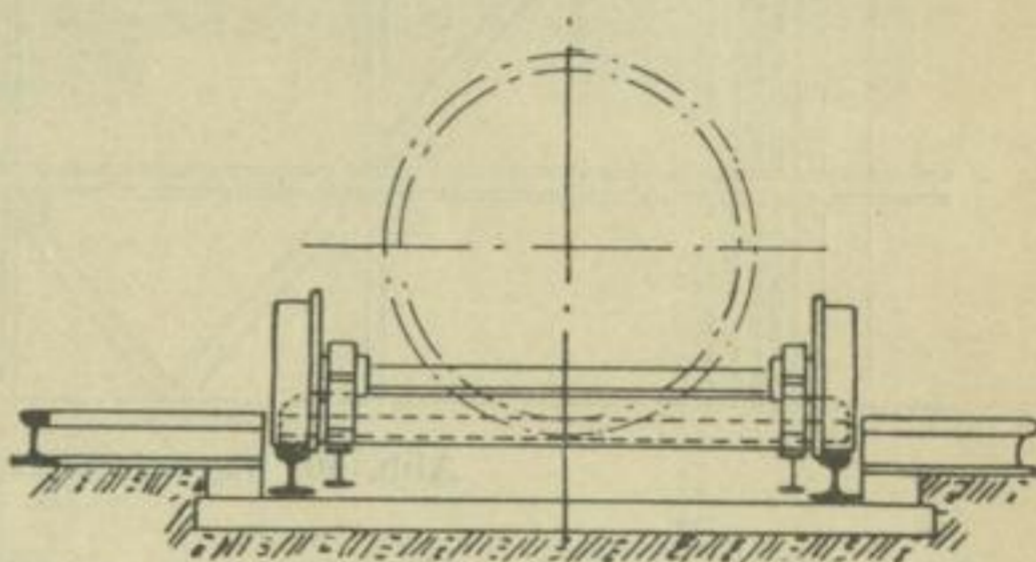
Schiebebühne mit Laufgrube für Achsen.
